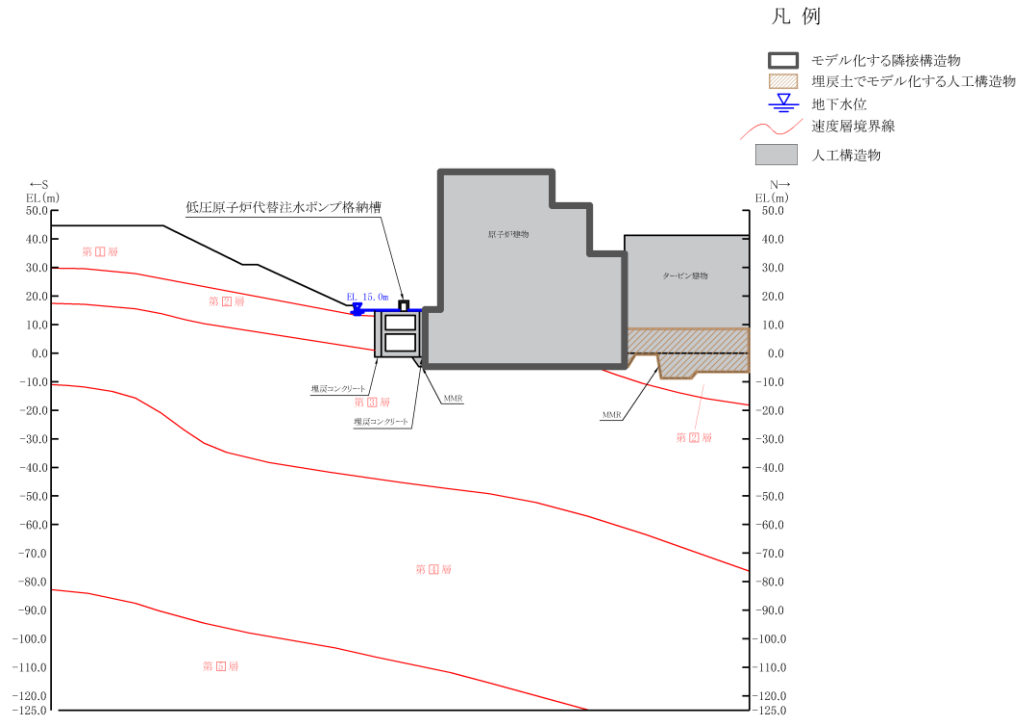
低圧原子炉代替注水ポンプ格納槽 評価対象断面図 (A-A断面)
